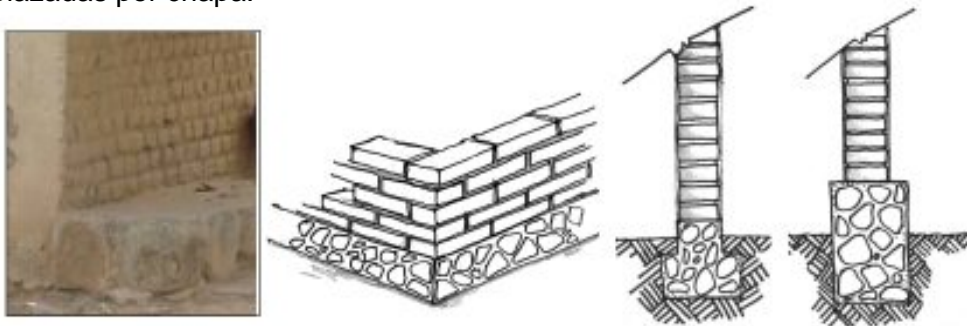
Los constructores del ámbito Aconquija tucumano utilizan sobrecimientos de piedra para nivelar el terreno y proteger el adobe de la humedad.
